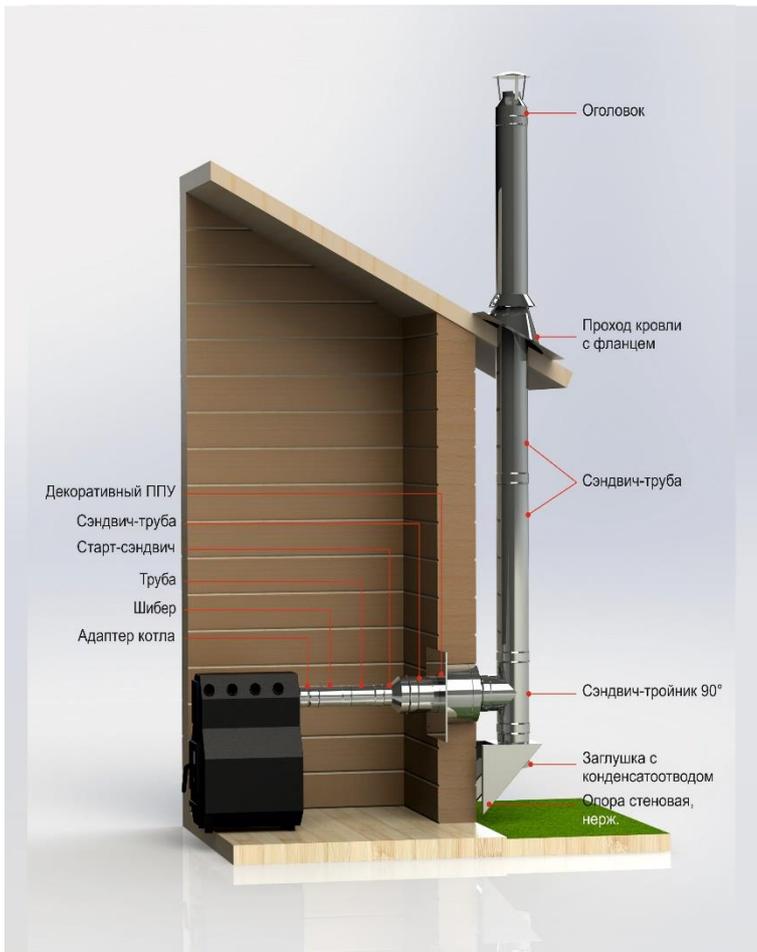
Двустенный вертикальный дымоход на внешней стороне стены с проходом через стену и кровлю при горизонтальном выходном патрубке котла.
